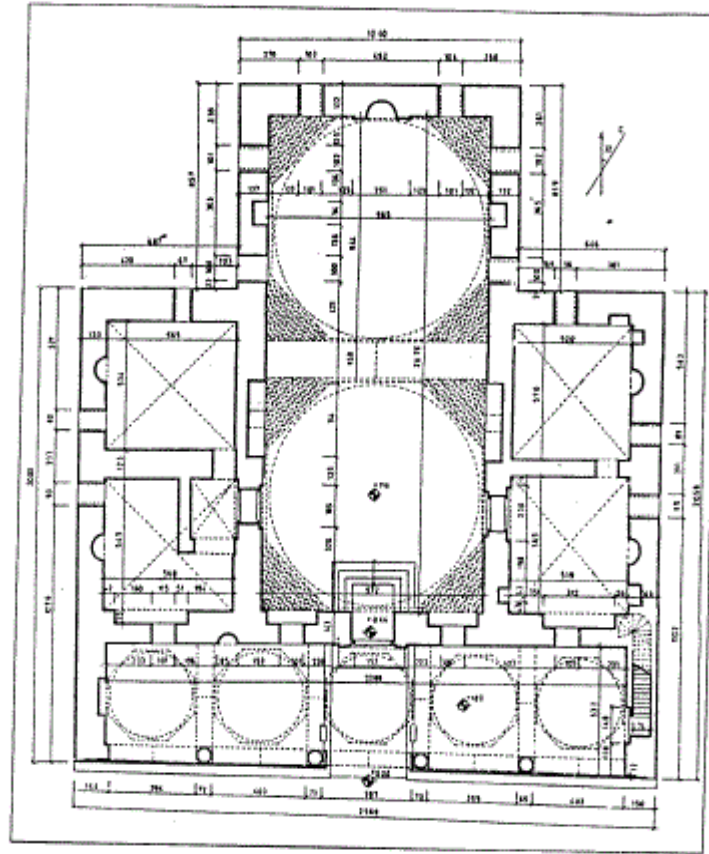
مسقط أفقي لمسجد Mezit bey في أدرنة (عن: أصلان أبا)
